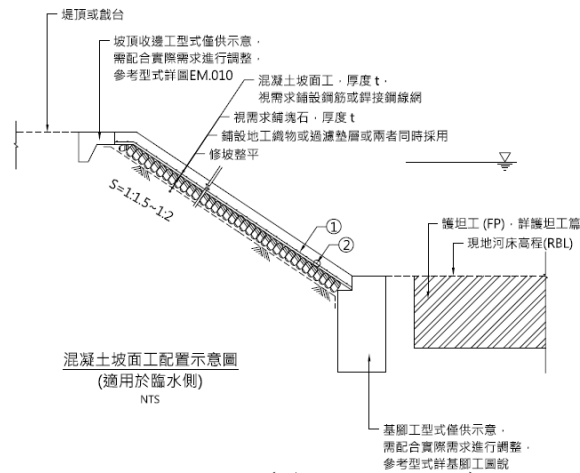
混凝土坡面工(含下鋪塊石)斷面示意圖
